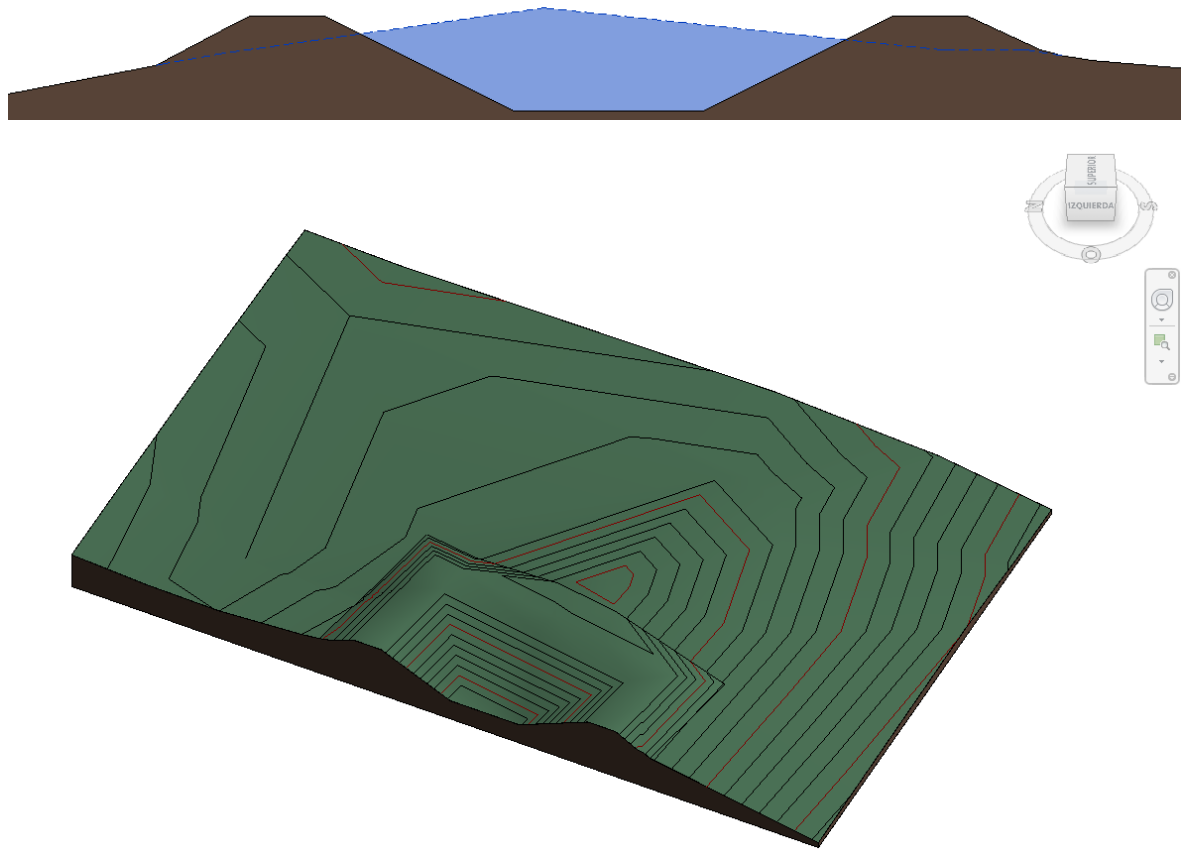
Sección y corte del terreno (terreno original en sombreado azul).
